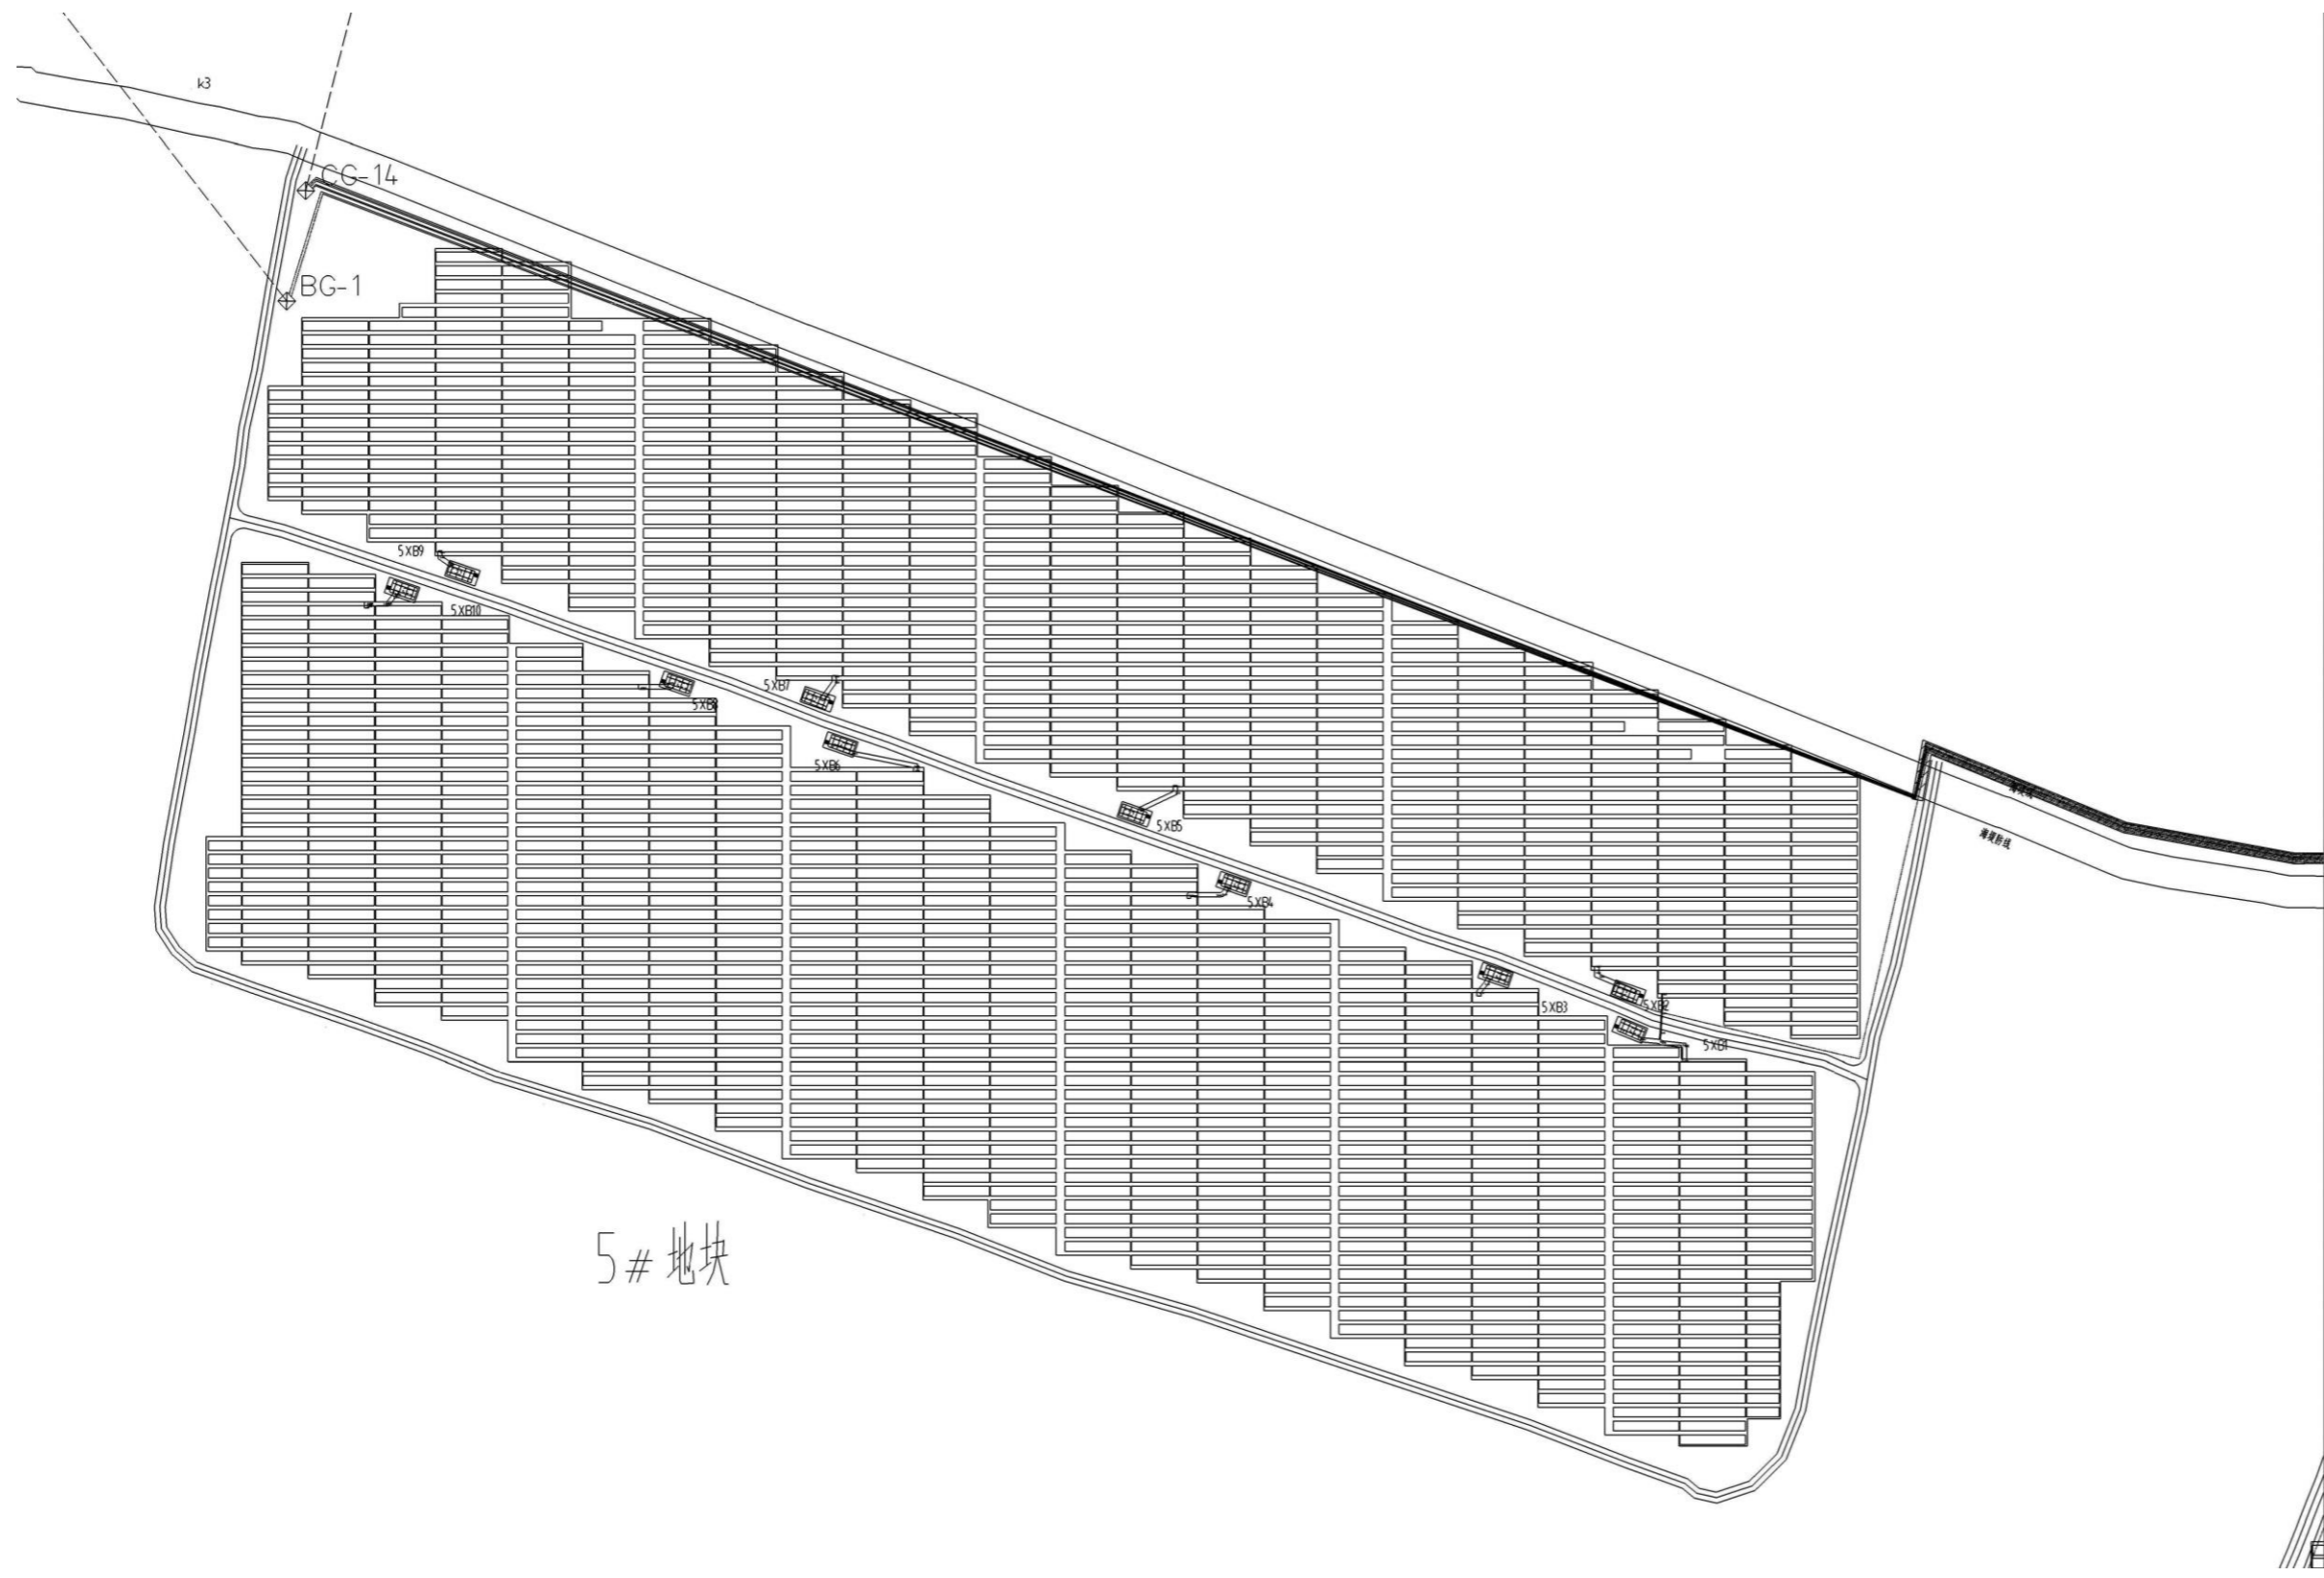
光伏区平面布置图（白沙新冲南围）
